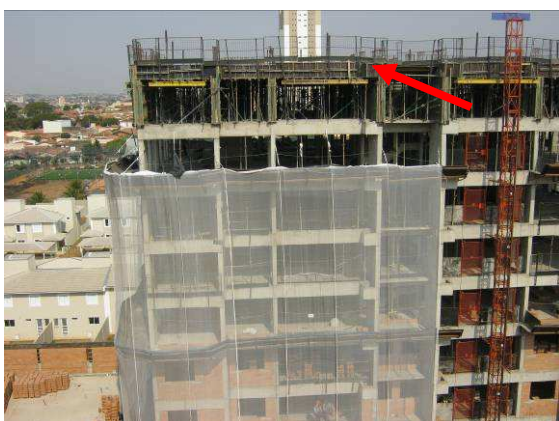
Sistema GcR Orman para proteção de poço do elevador – Obra 9
